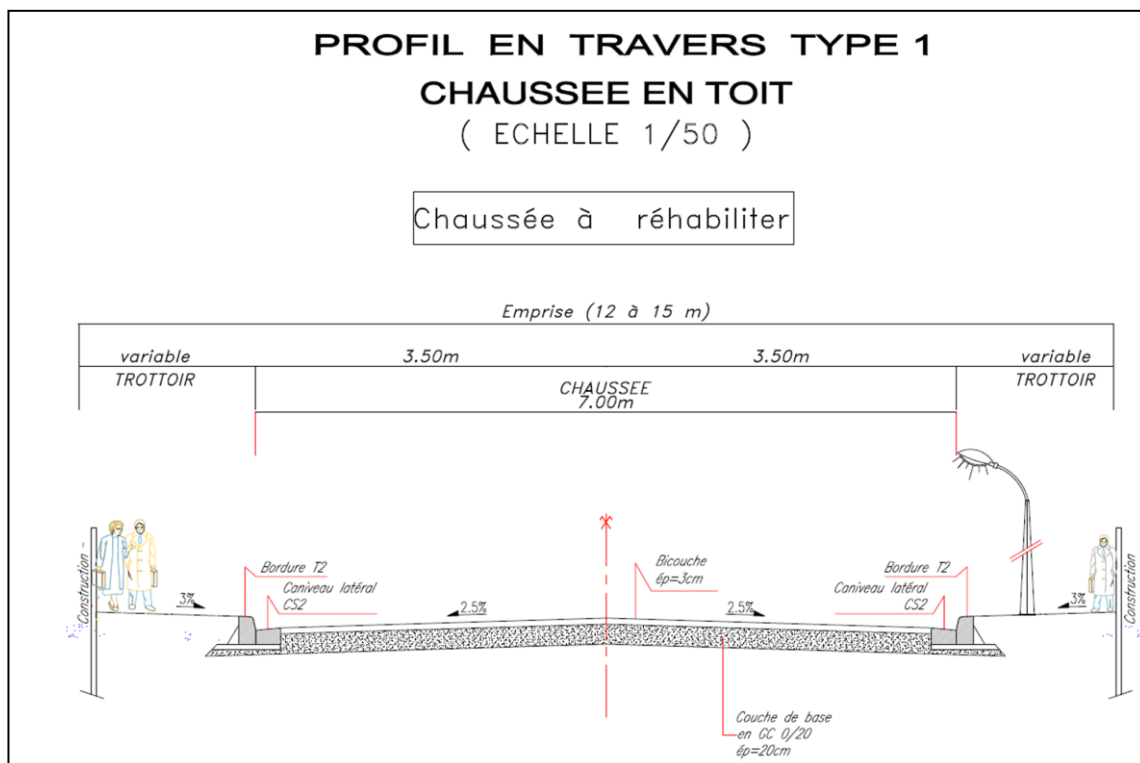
Coupe type du corps de chaussée-Aménagement type 1
